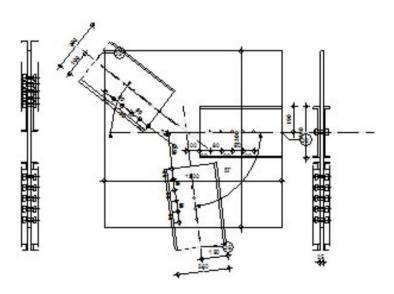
Vérification d'assemblage de contreventement en V (2UPN380)
